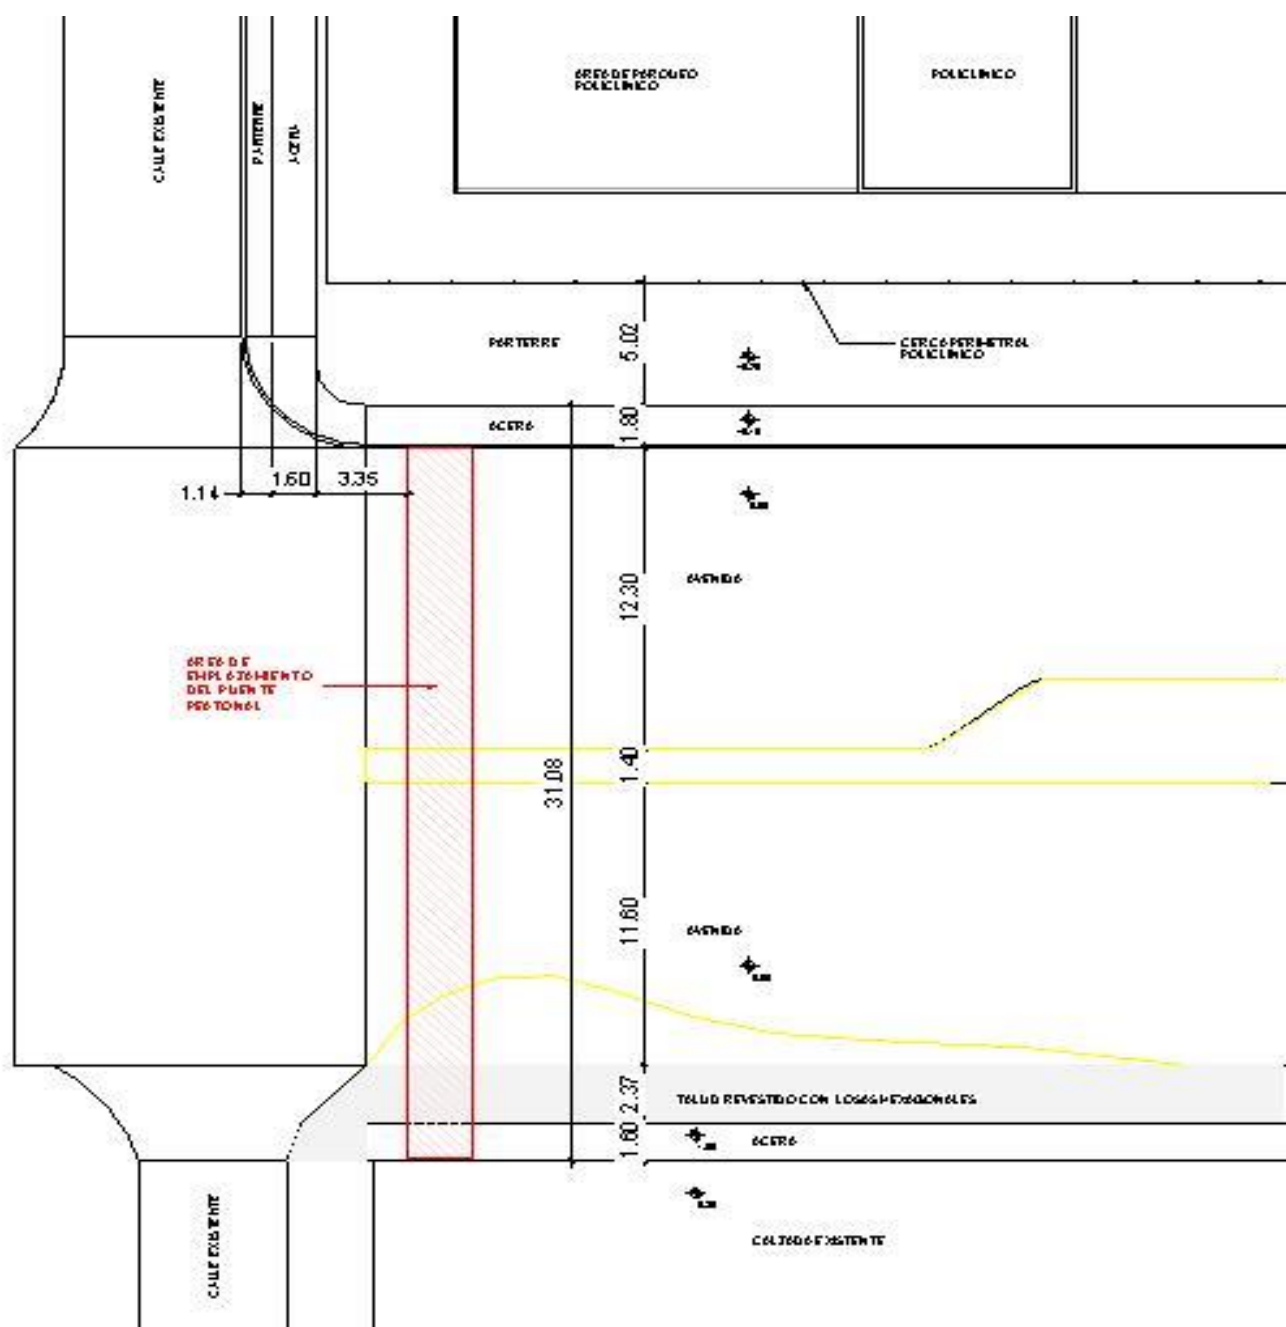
Levantamiento emplazamiento puente peatonal La Plaquita. Fuente: Carballo (2020)
